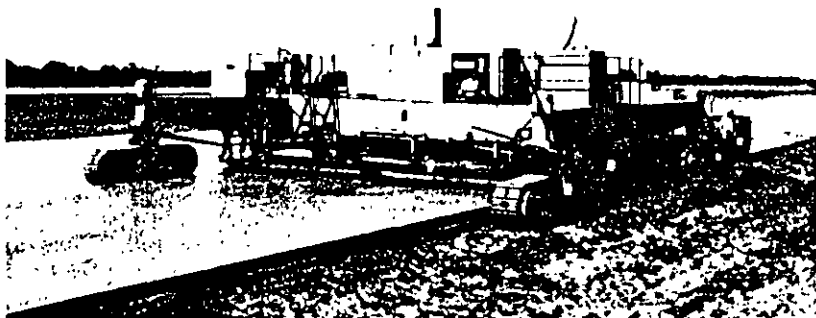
Pavimentadora de formaleta deslizante guiada por palpadores de alambre.
